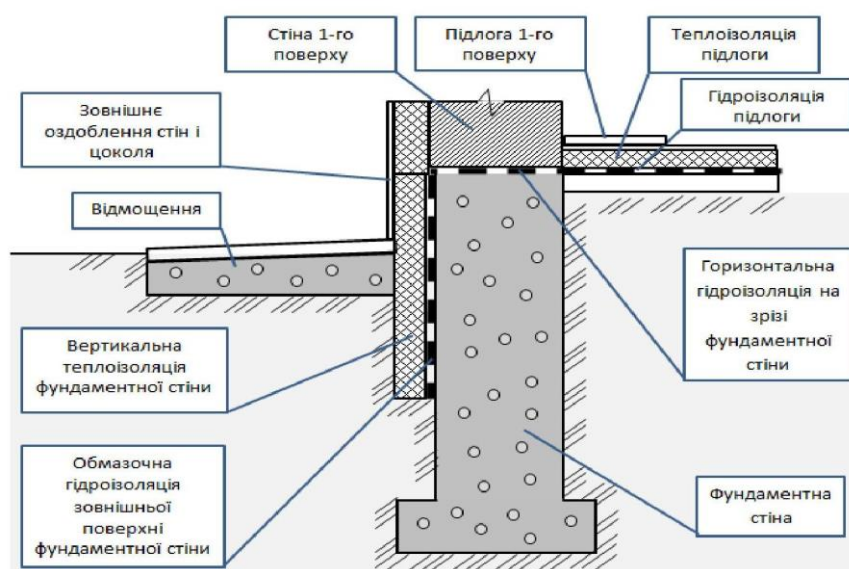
Утеплення фундаменту плитами полістиролу, які розміщені вертикально на зовнішній поверхні фундаментної стіни [6]
